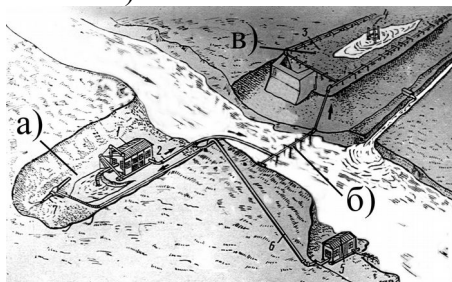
Схема выполнения гидромеханизированных земляных работ.
